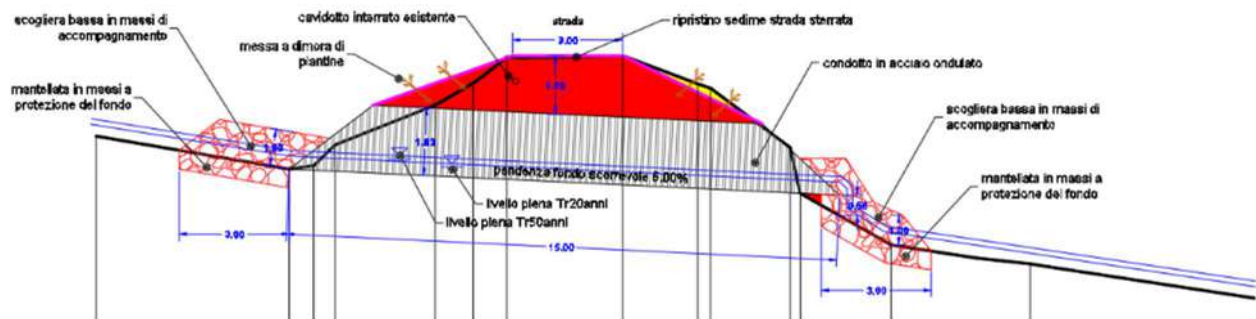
Sezione tipo. (rappresentazione non in scala)
